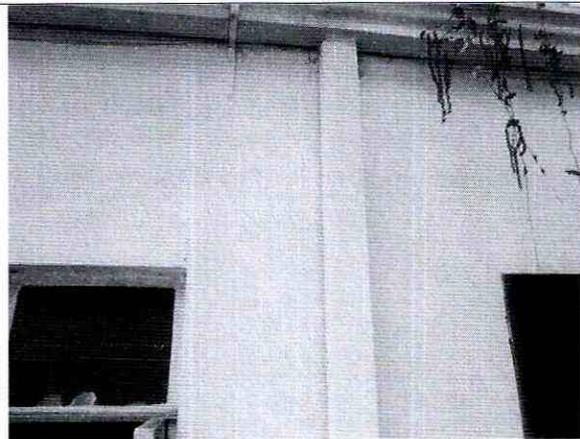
Grieta vertical en muro de segundo piso.
